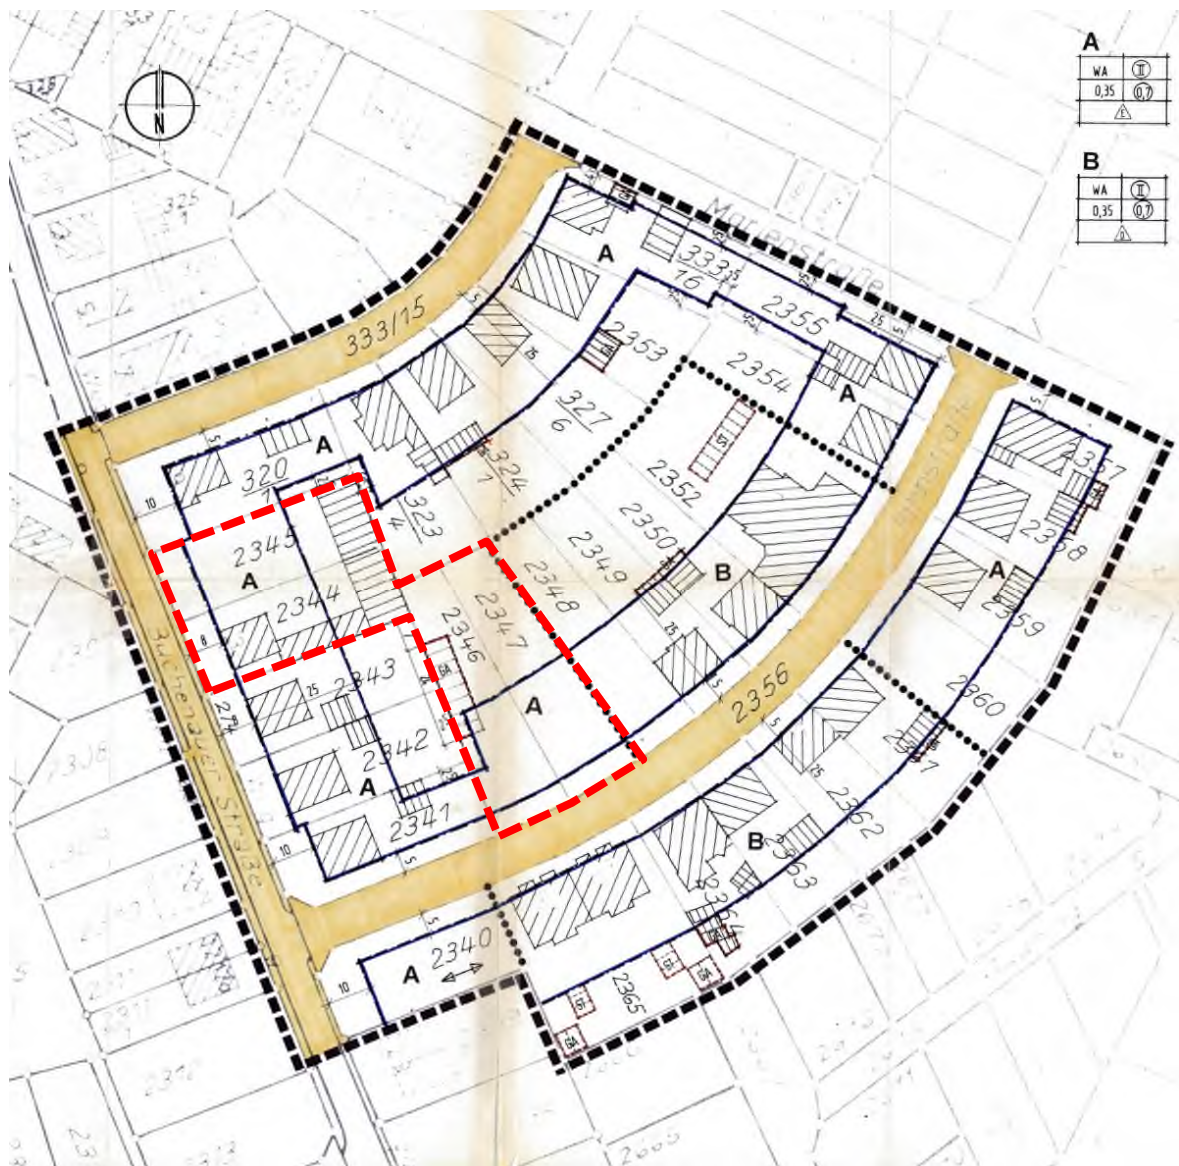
Bebauungsplan „Auf das Dorf“ - Teilaufhebung und Neuaufstellung, 1995 mit Plangebiet (rot)
